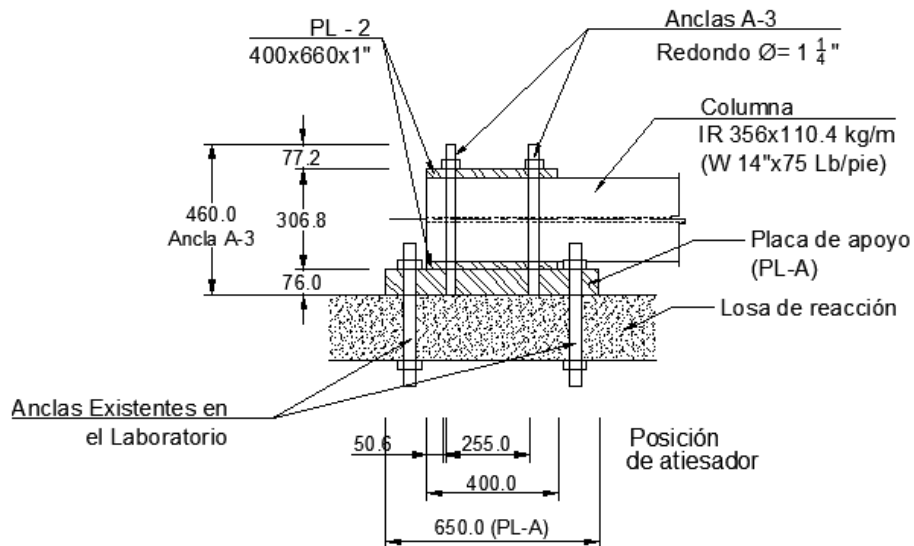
Detalle de los apoyos, vista lateral (Corte A-A). Cotas en milímetros
